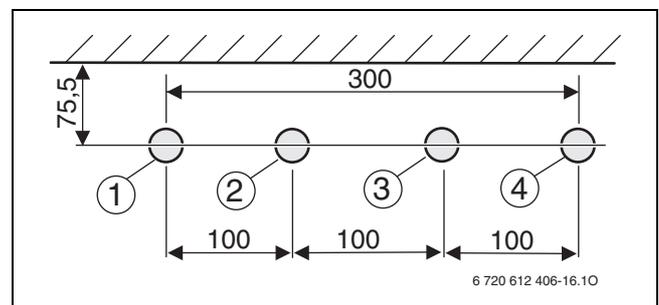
Misure per l'installazione dei collegamenti da parte del committente
